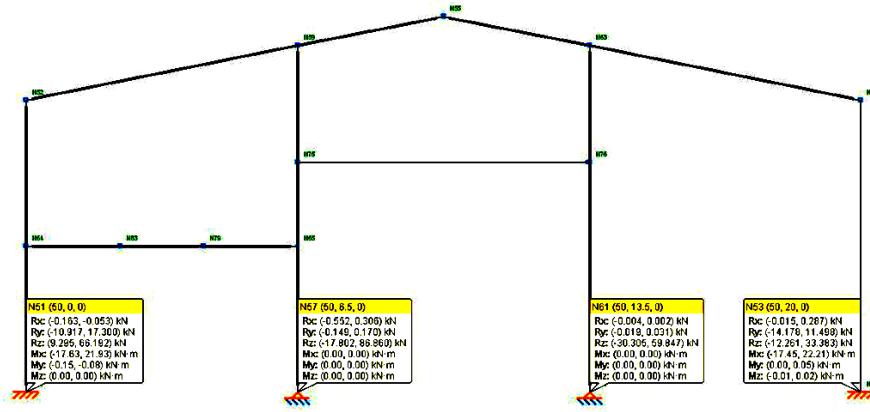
Reacciones en el pórtico hastial con entreplanta
